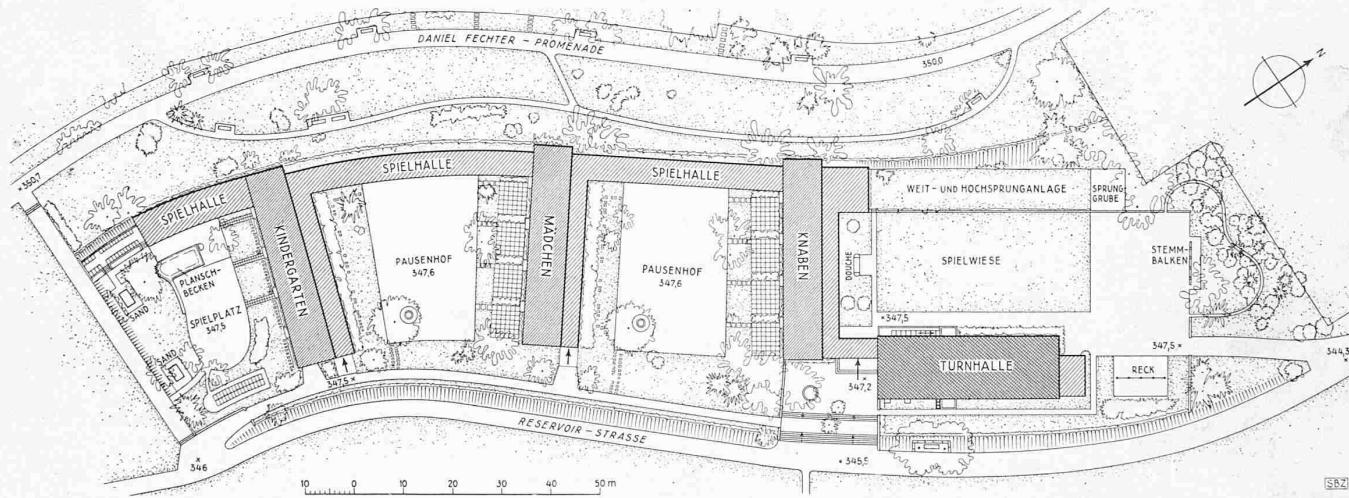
Lageplan der Schulhausanlage mit drei Flügeln zu je vier Klassenzimmern. — Masstab 1:1400
